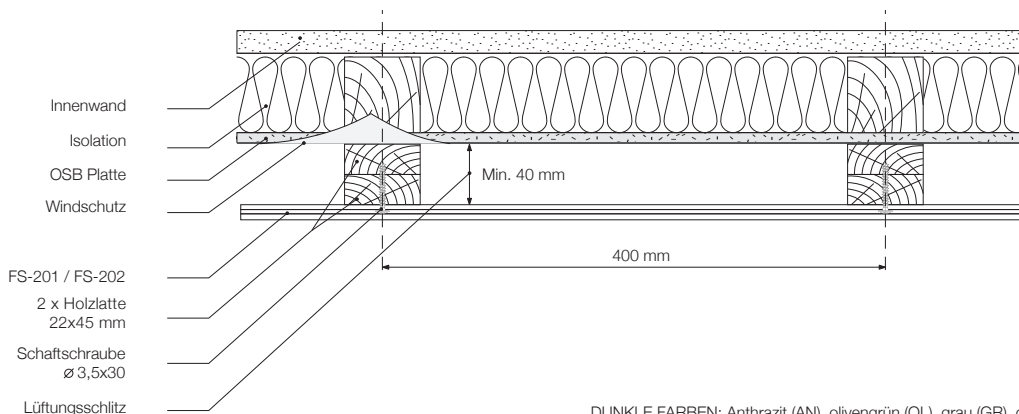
Lüftungsschlitz, erforderlich bei Paneelen mit hellen, Gerüstkonstruktion - horizontaler Schnitt
